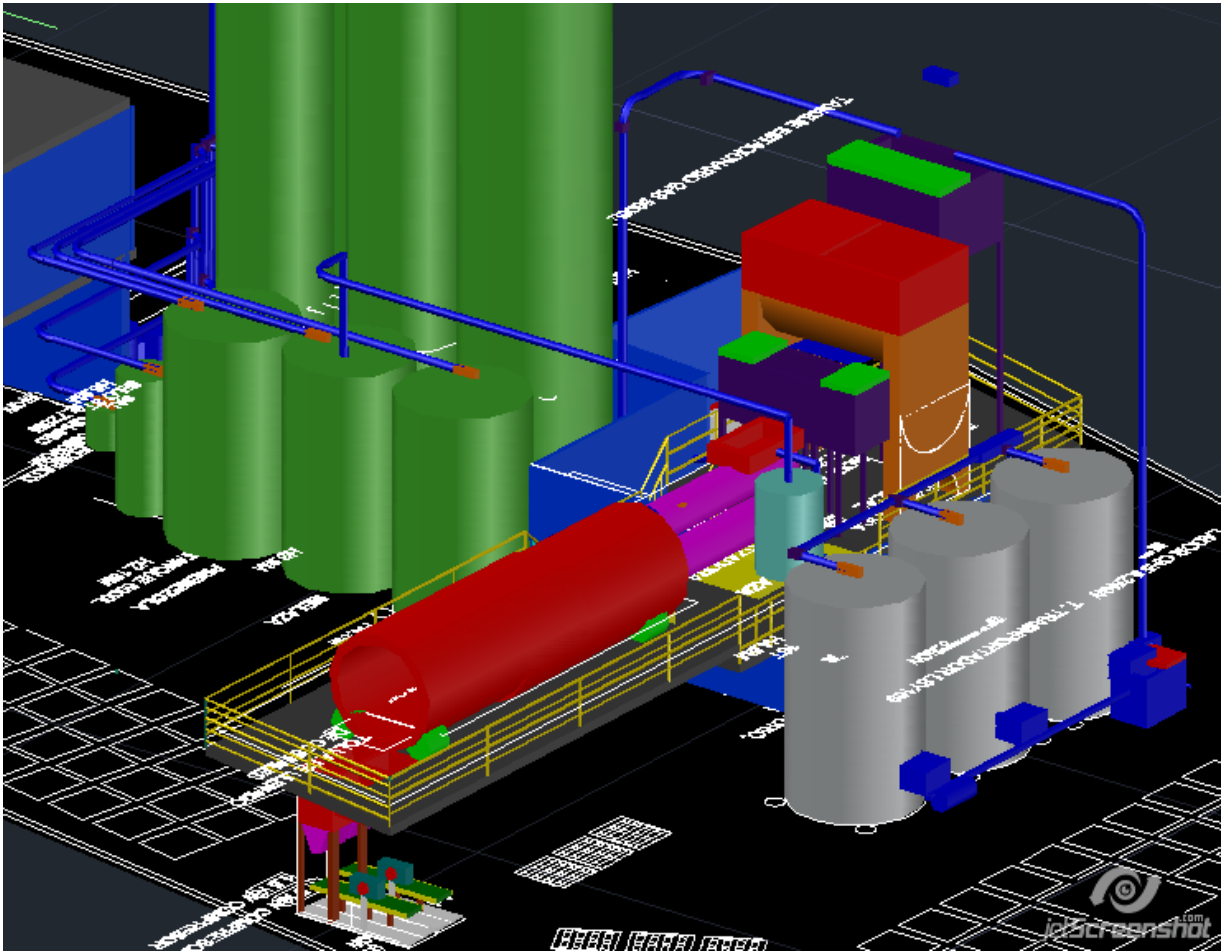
Vista lateral derecha de la planta incluyendo sistema de transporte (tuberías azules).
